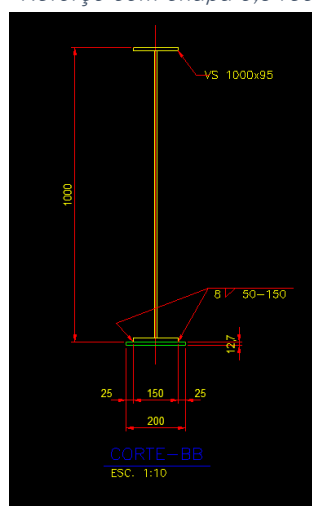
Detalhe Corte - BB - Reforço com chapa na parte inferior da viga travessa.
